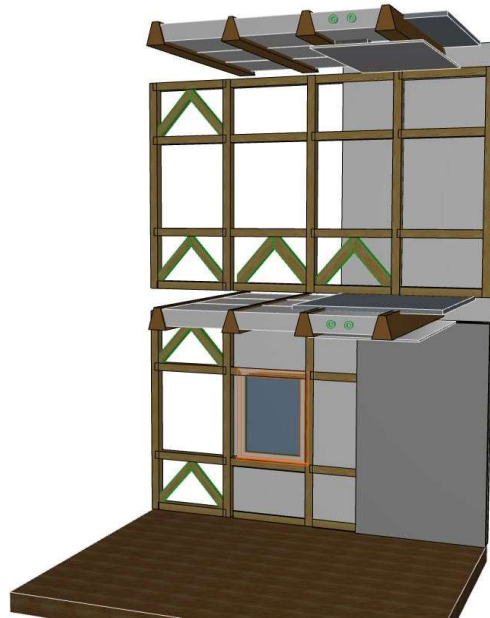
Holz-Beton-Holzleichtbetondeckenelemente in einem dreigeschossigen Gebäude mit Holztragwerk.
